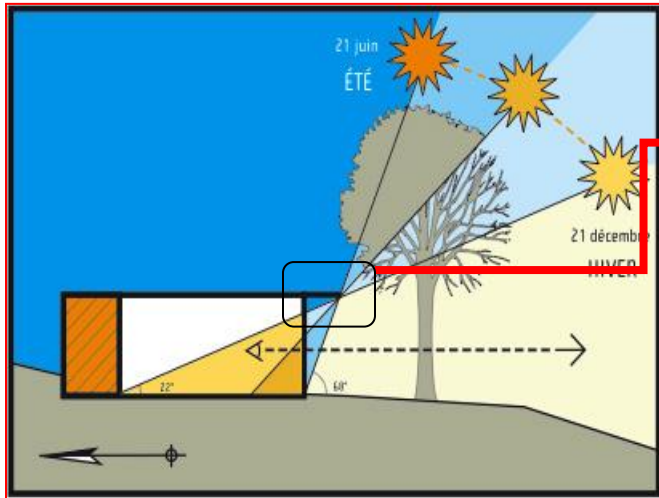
Coupe schématique qui présente type brise solaire horizontal. source : Les protections solaires
